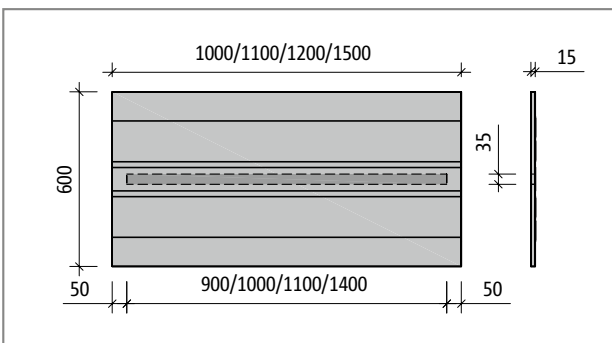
Schöck Tronsole® Typ B-V1-L...-B600: Produktgrundriss
